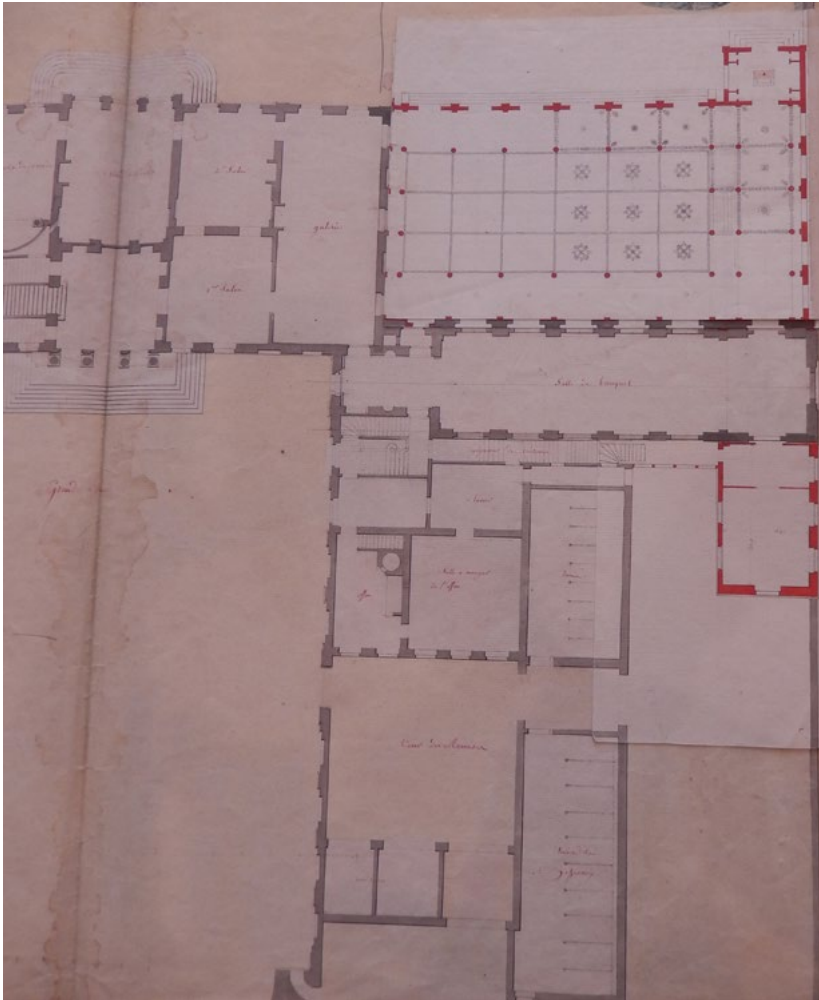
Étienne-Chérubin Leconte (attribué à), plan partiel du rez-de-chaussée de l'Élysée après la construction de l'escalier d'honneur et de la salle de banquet. Détail de la grande salle des fêtes [sur retombe] en prolongement de l'aile ouest, pour Joachim Murat, grand-duc de Berg et Clèves, dessin crayon, encre noir et aquarelle, s.d. [avant 1808]. Paris, Archives nationales, Cartes et plans, VA XII, 5 (© Geoffroy, Guidoboni 2018).
